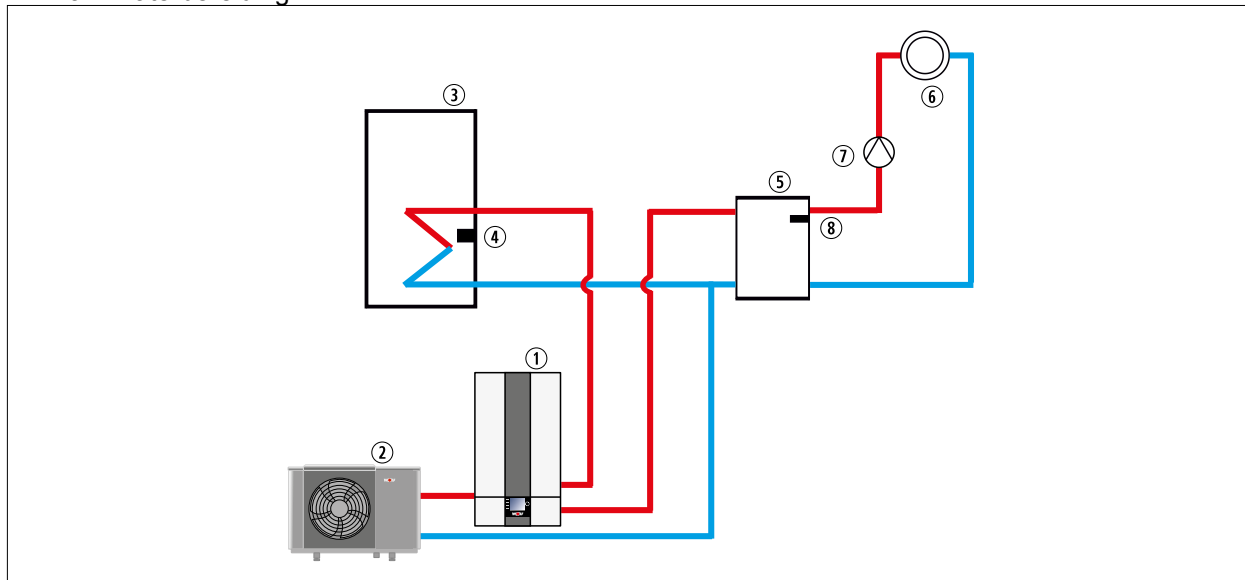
Installatieconfiguratie 02, voorbeeld 2
